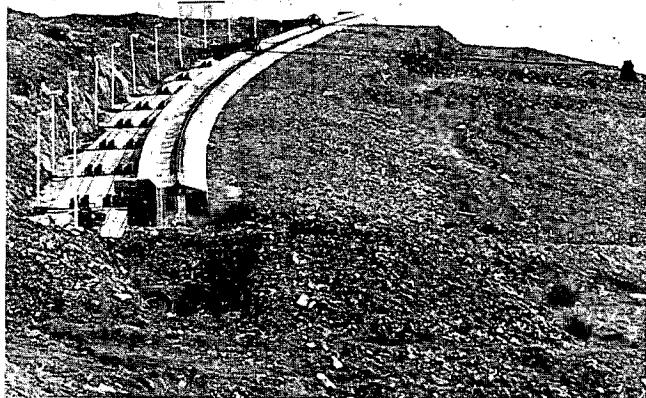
Vista del camino de rodadura inclinado del minicarro.
